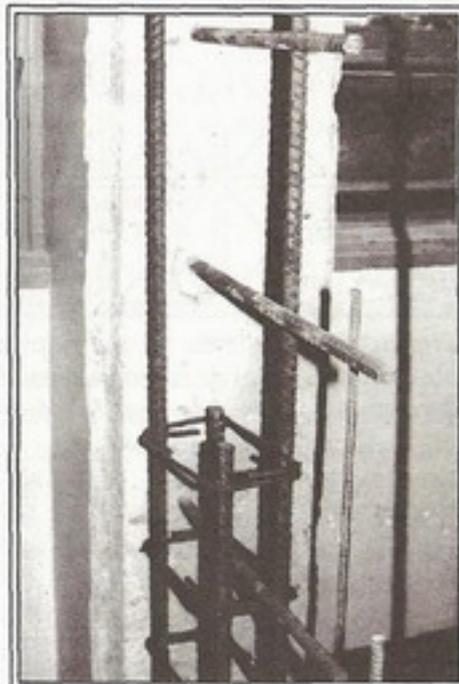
Refuerzo vertical y de confinamiento en los extremos de muros estructurales.
